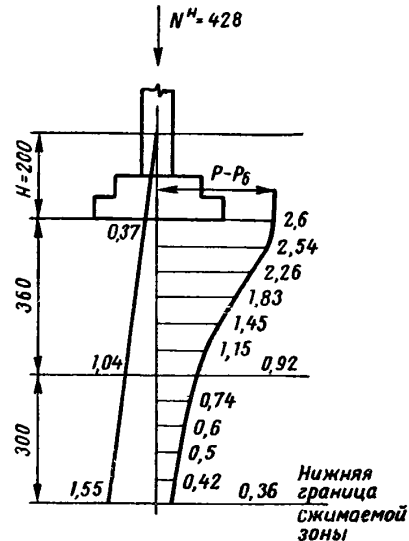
Расчет осадки фундамента на пластичномерзлых грунтах
